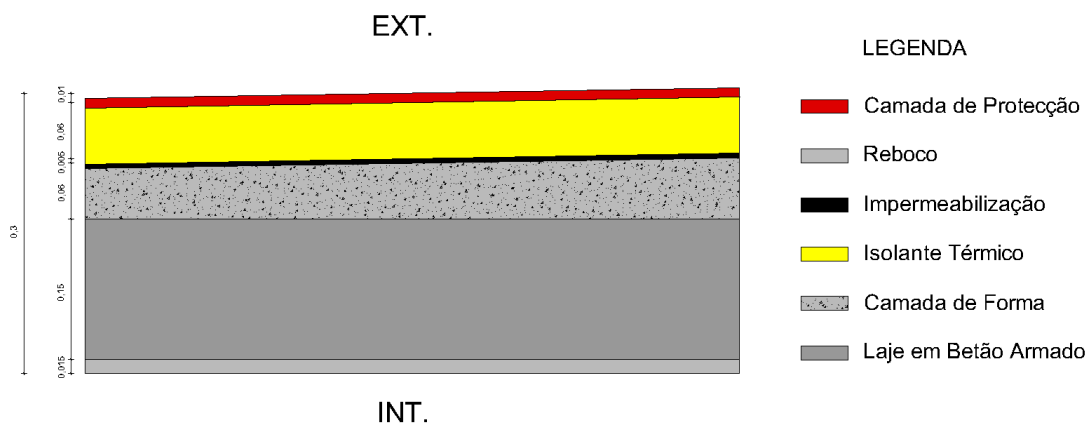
Cobertura plana tradicional com isolamento térmico sobre a laje
